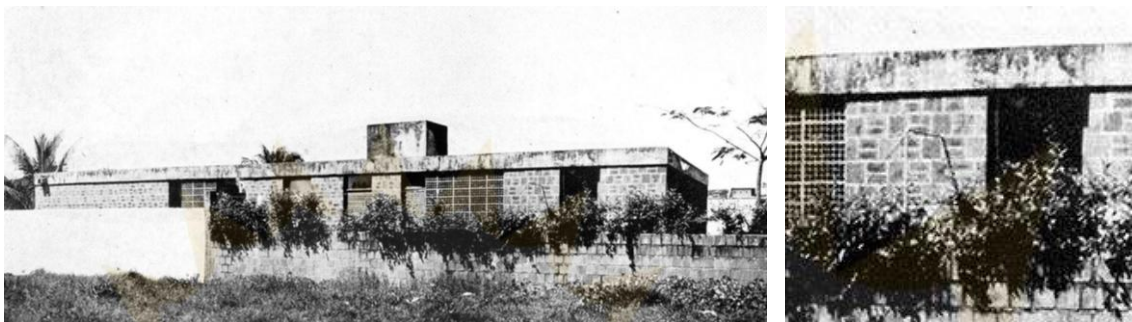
Vista lateral da casa com parede portante em tijolo e cinta superior. Ao lado detalhe do assentamento do tijolo.
